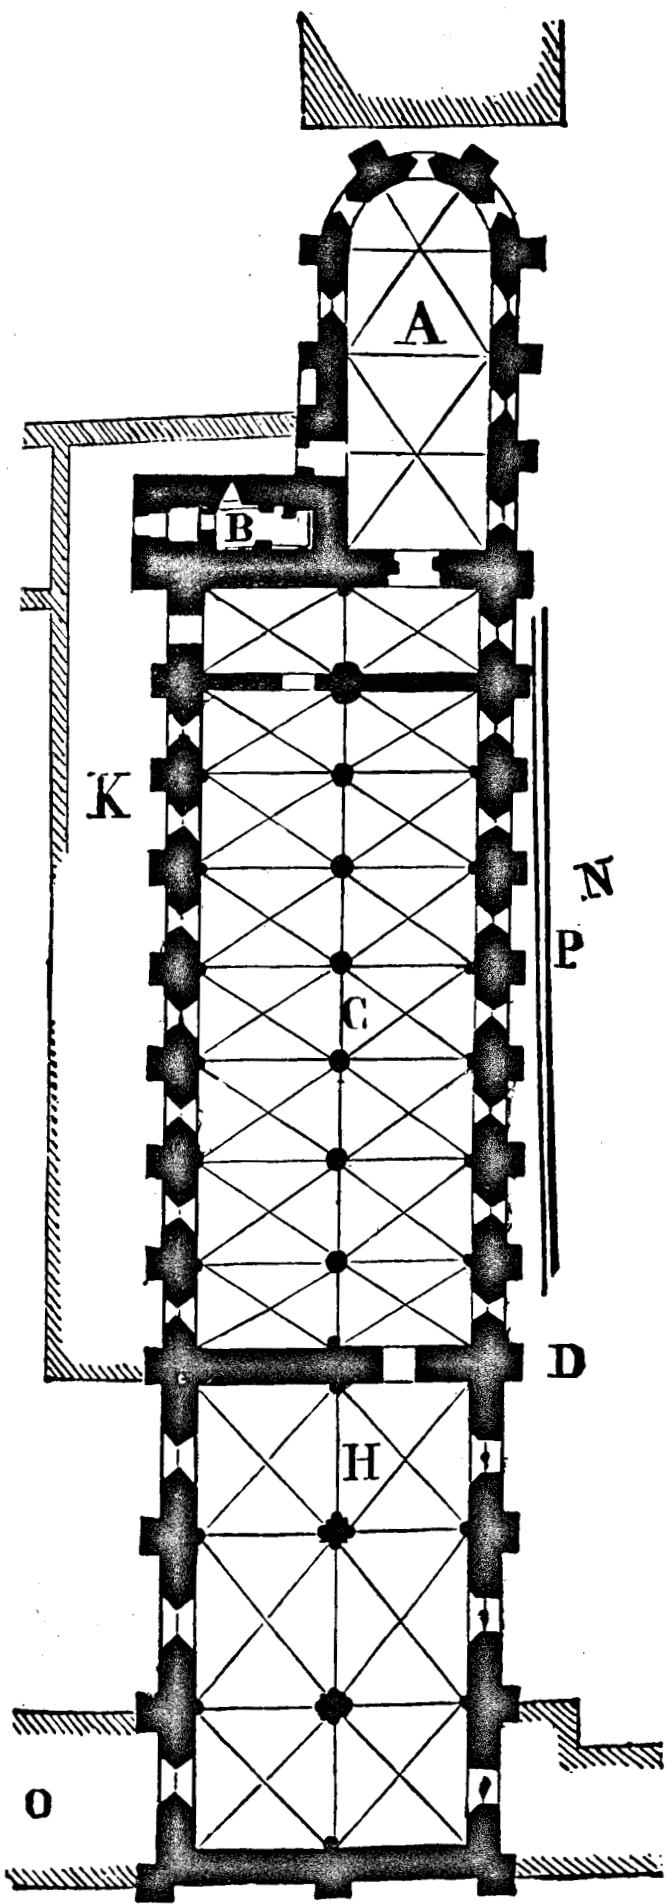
Paris, plan du Palais épiscopal (d'après Viollet-le-Duc, *Dictionnaire*). Échelle 1/400.
